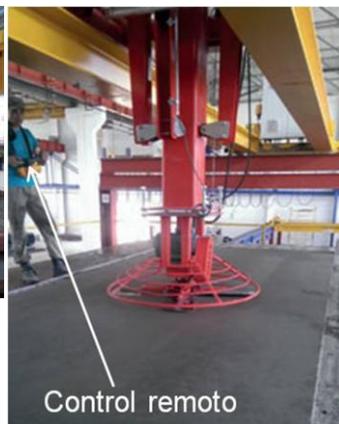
Estación para el alisado y terminación del componente prefabricado. Fuente: <https://www.youtube.com/VollertAnlagenbau>
